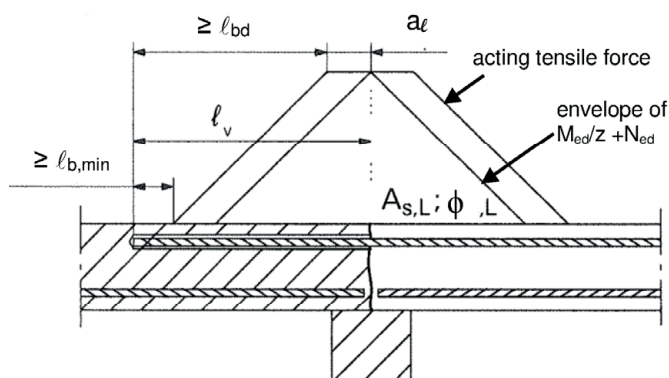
Anclaje final de losas o vigas (por ejemplo, diseñadas como simplemente apoyadas)
